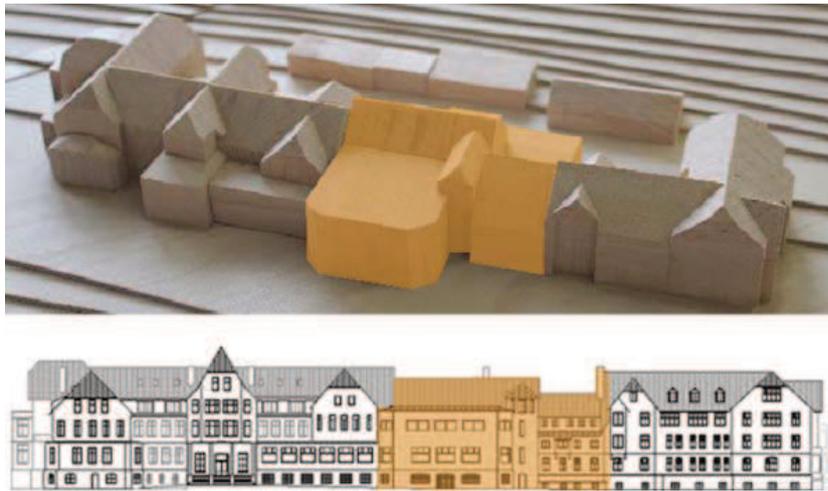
Modell mit Intervention und bestehende Fassade mit Intervention
